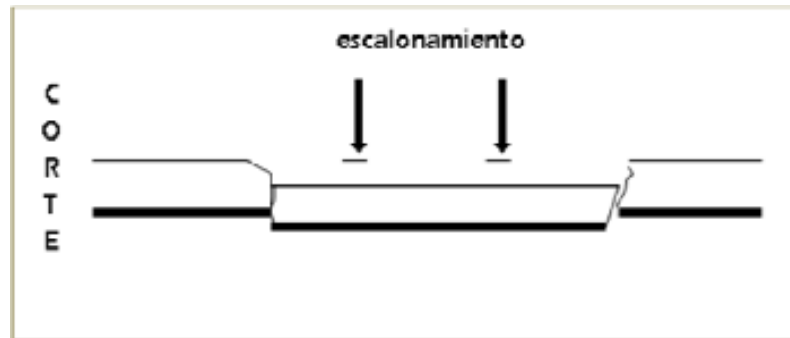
Esquema de la vista en perfil de un escalonamiento transversal de una junta con la grieta.
